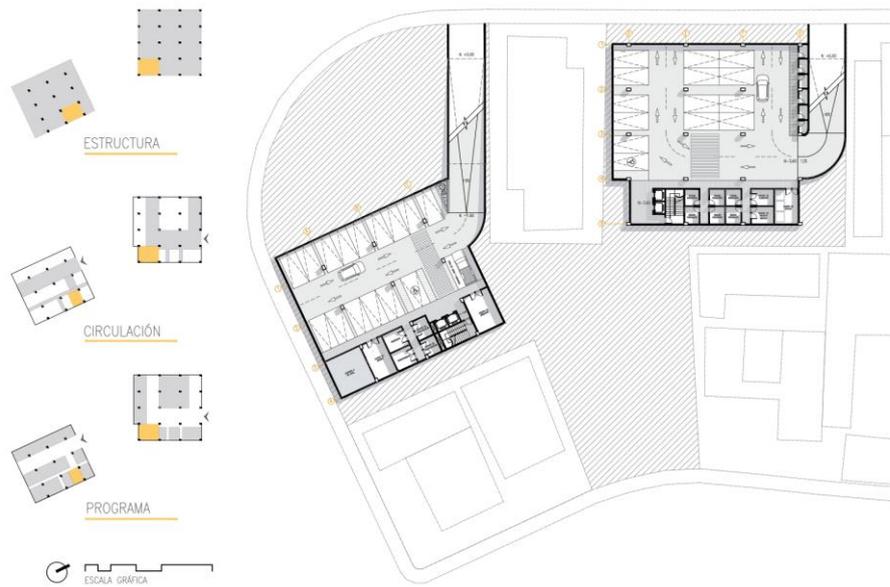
Planimetría: Planta subsuelo (N-3.60). Elaboración propia.
